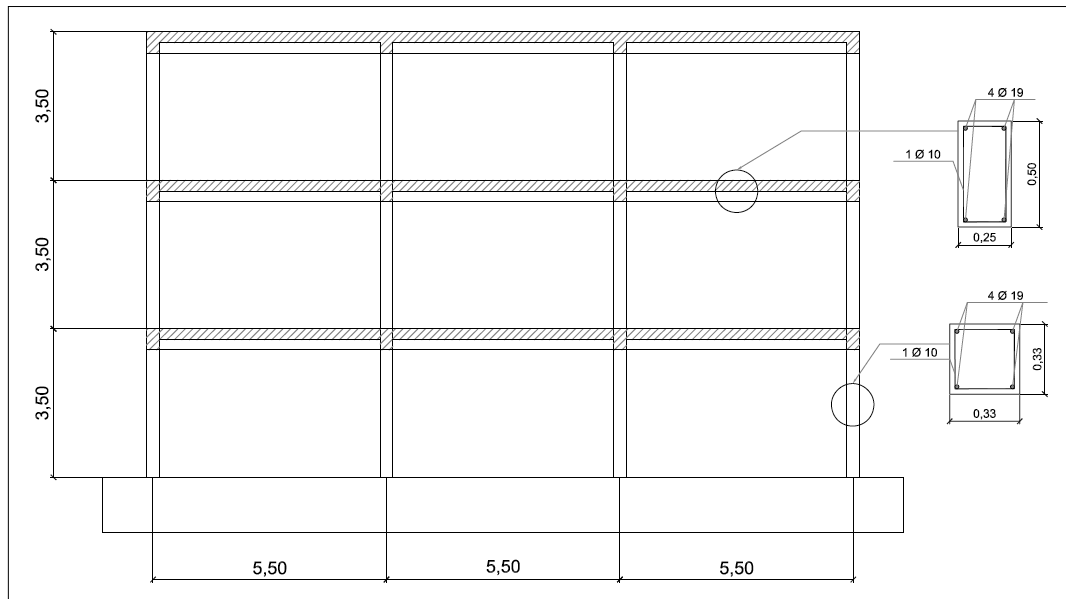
Geometría general y secciones transversales del pórtico de 3 niveles
